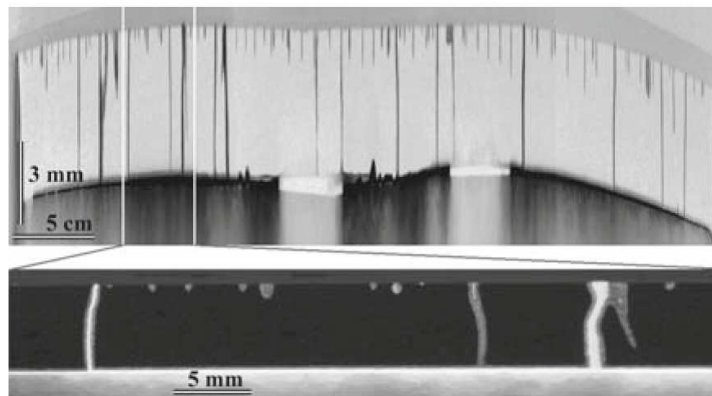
Distinção entre fissuras externamente restringidas e autorrestringidas adotado de [84]
